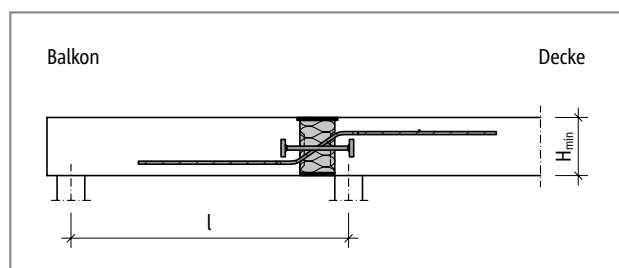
Schöck Isokorb® XT Typ QP: Statisches System
